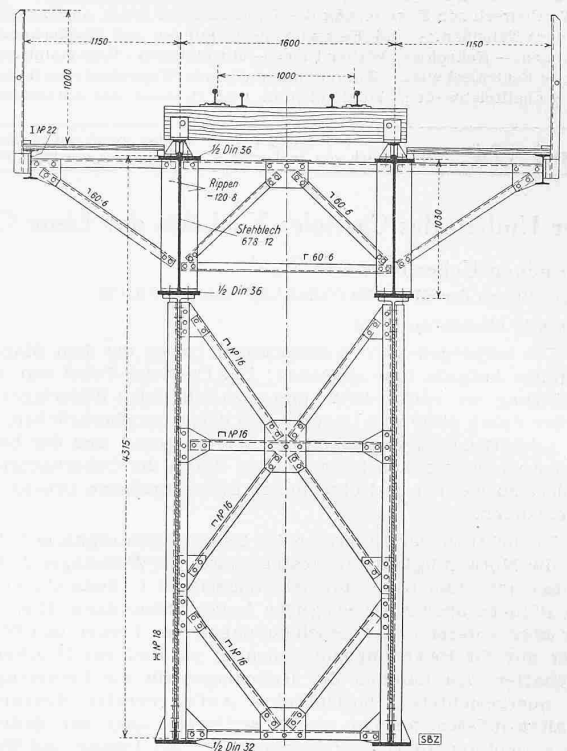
Querschnitt in Trägermitte. Masstab 1 : 50
